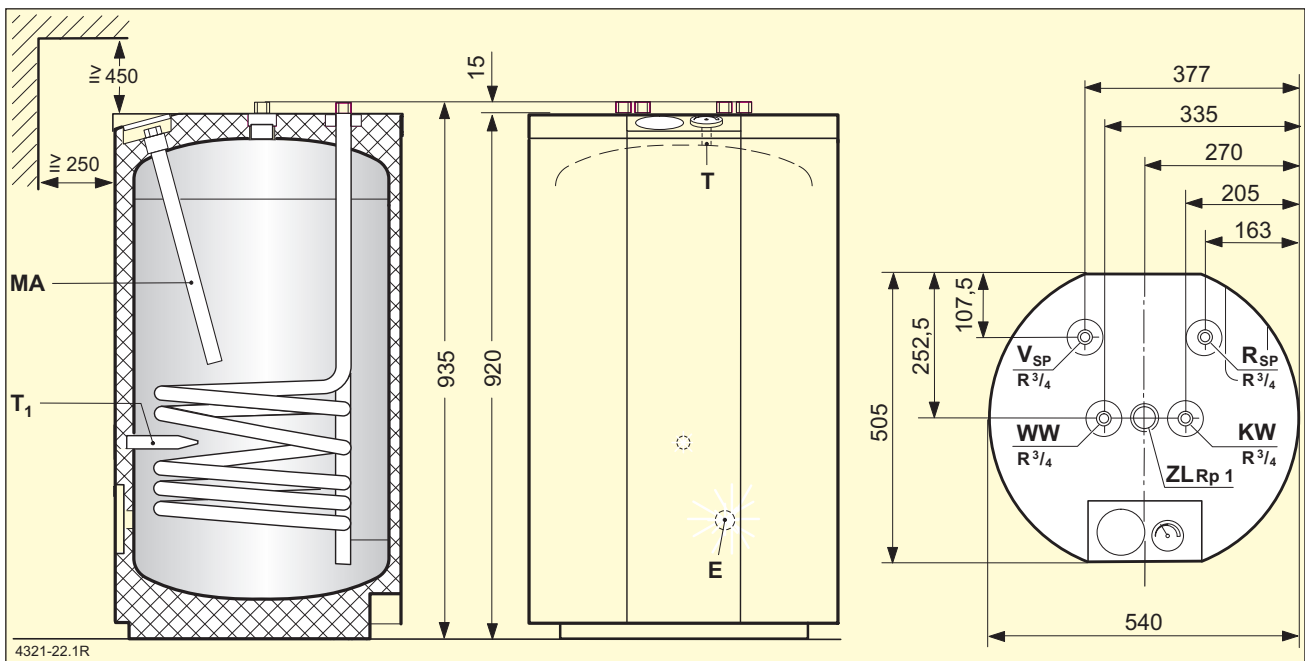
Bau- und Anschlussmaße ST 120-1 Z
